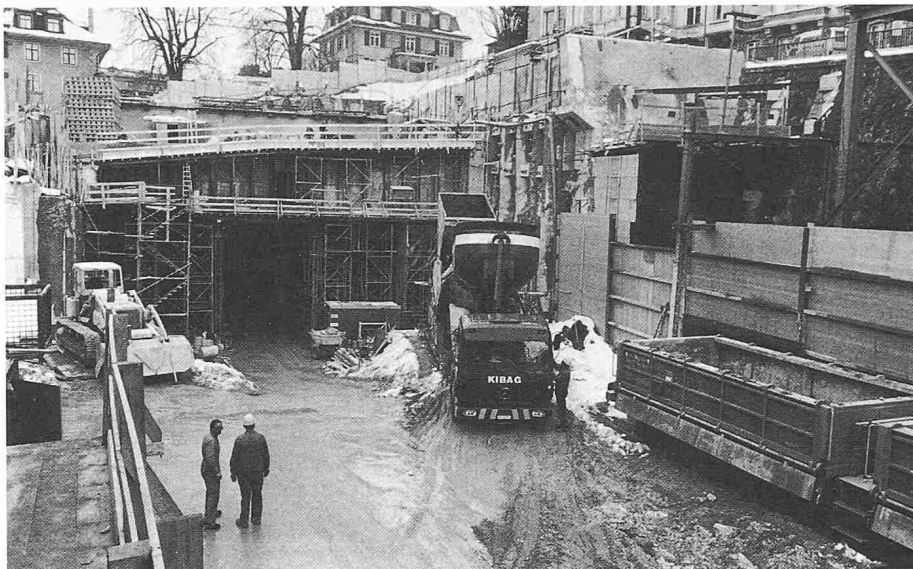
Tunnel Rämistrasse. Baugrube am Tunneleingang
